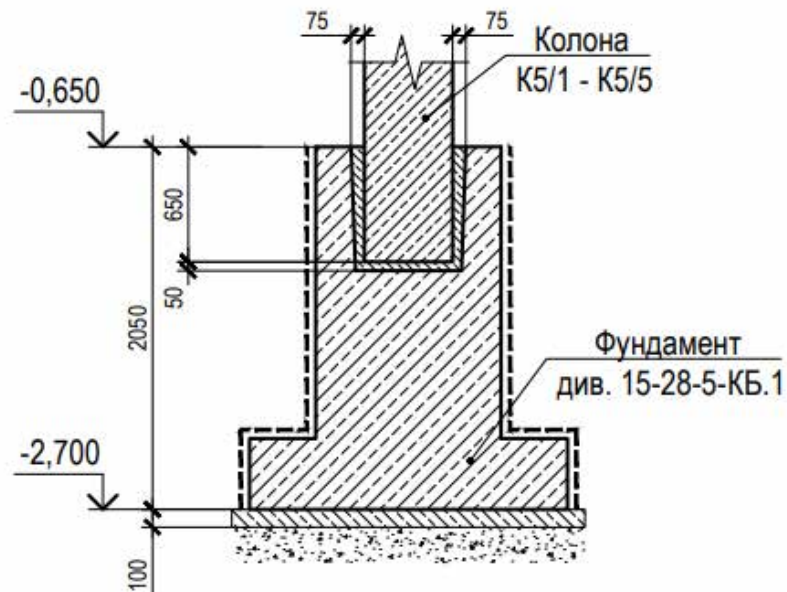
Монолітний залізобетонний фундамент стаканого типу
